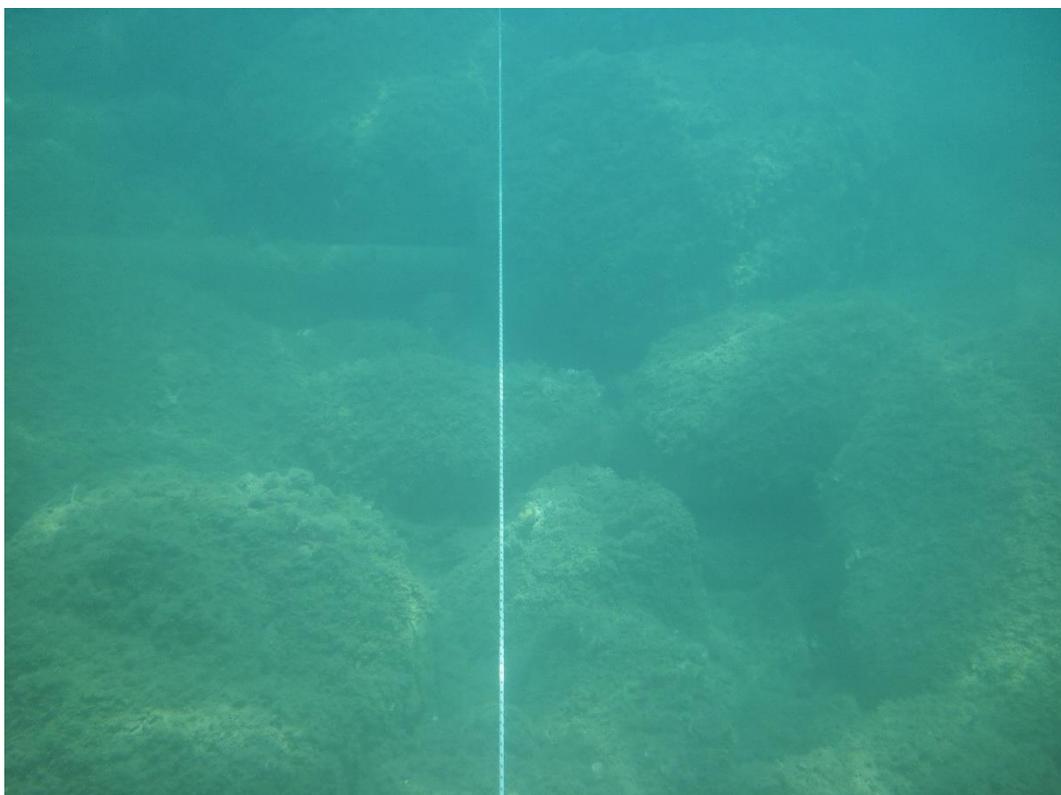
fondale Diga di Ponente 15 m dalla costa circa
